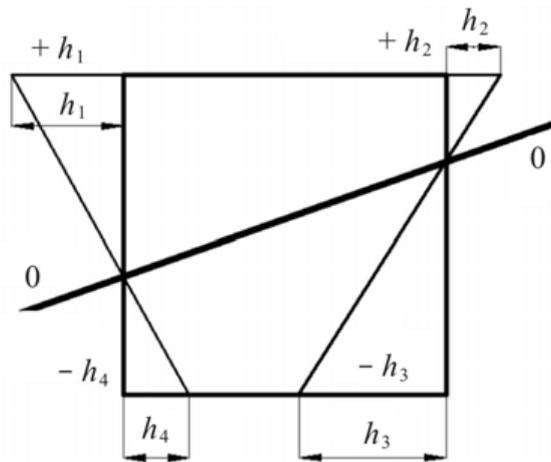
Графическое определение положения линии нулевых работ на планировочной сетке площадки
